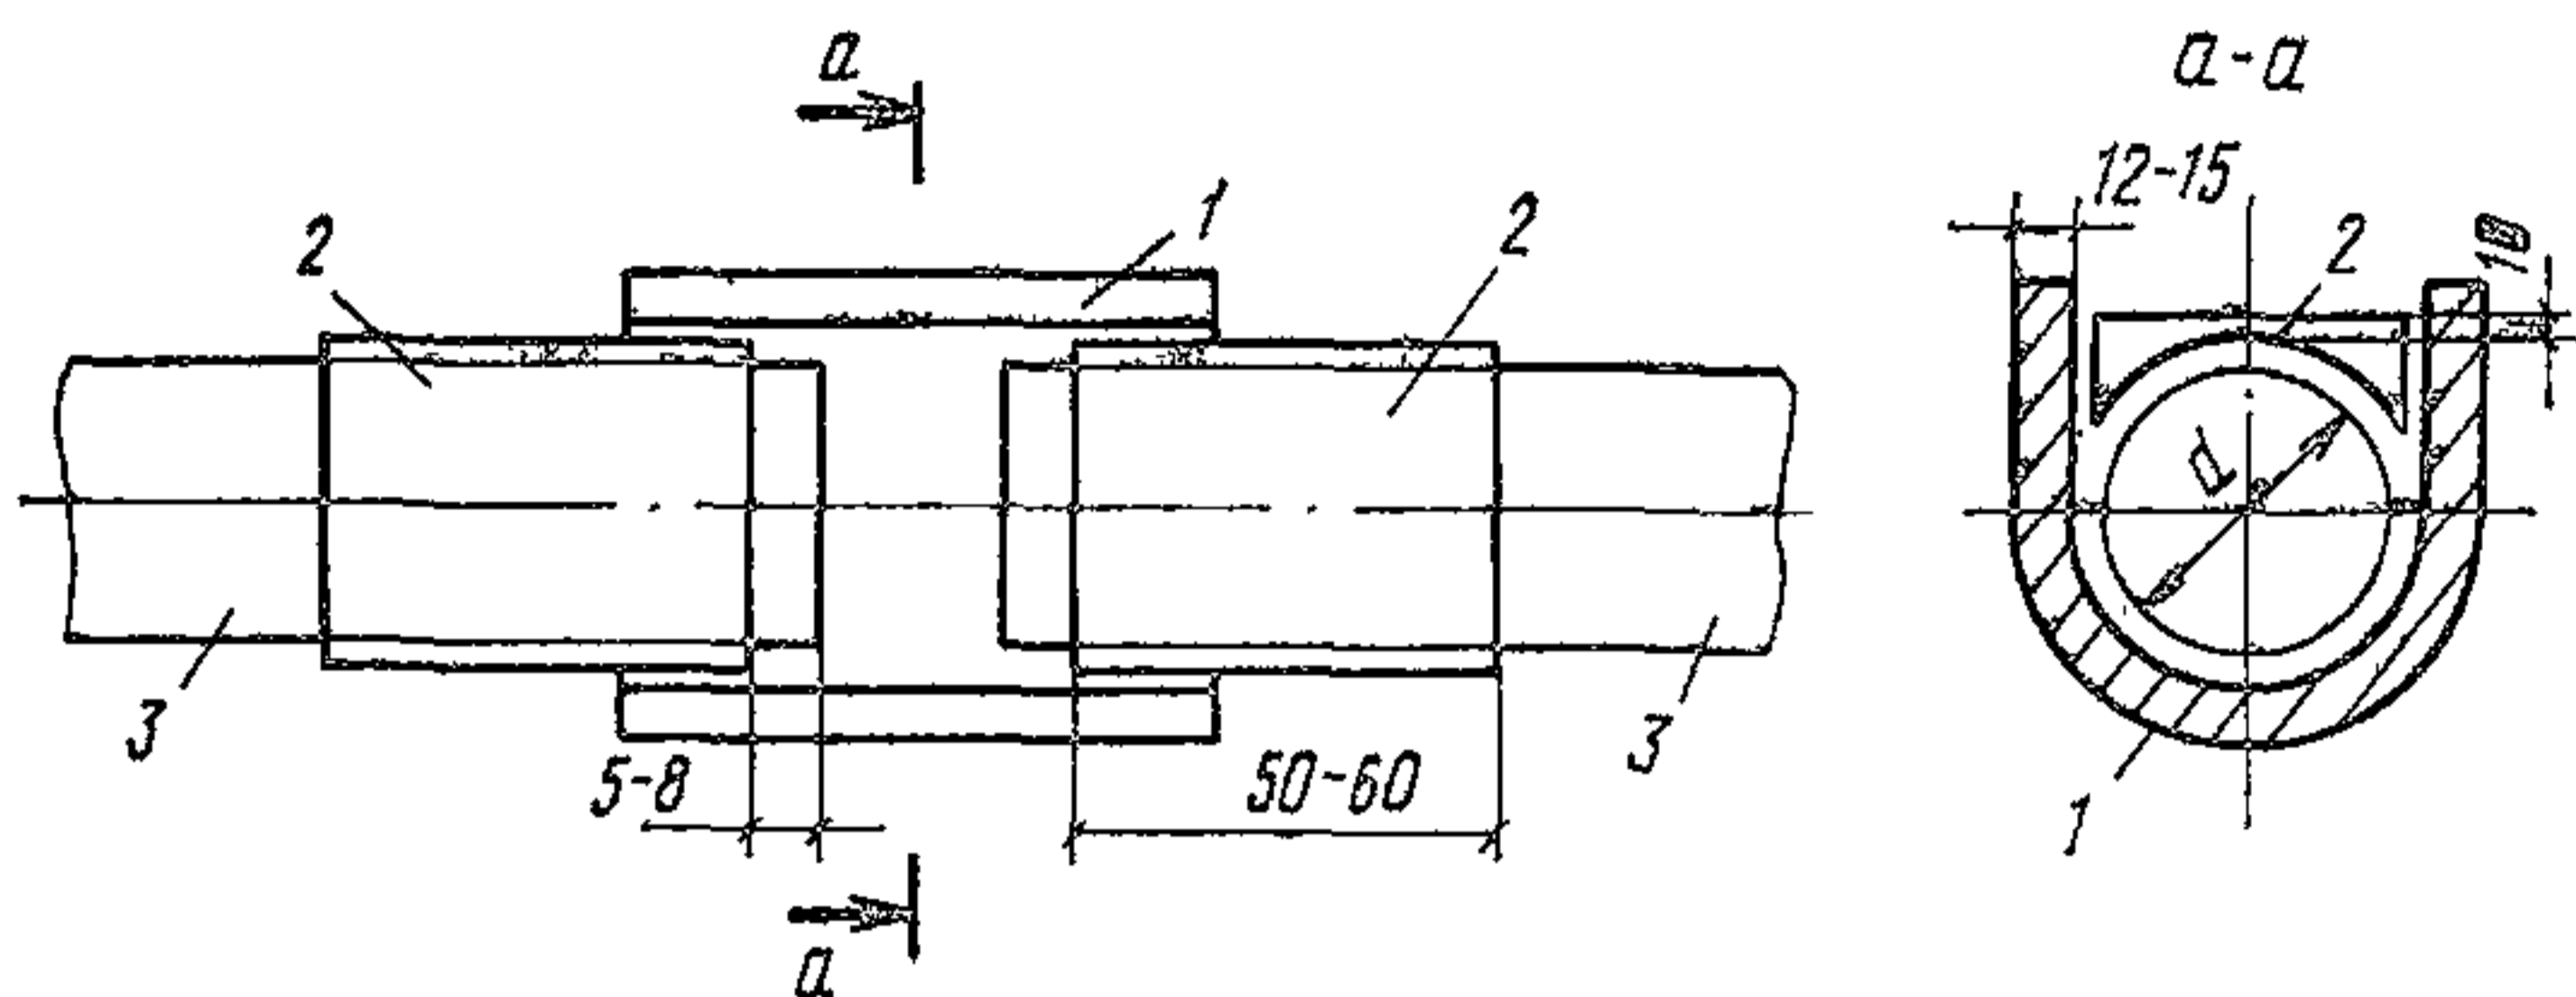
Схема установки желобчатой подкладки 1 и медных вкладышей-ограничителей 2 плавильного пространства при подготовке к ван-ной сварке горизонтальных стержней 3
